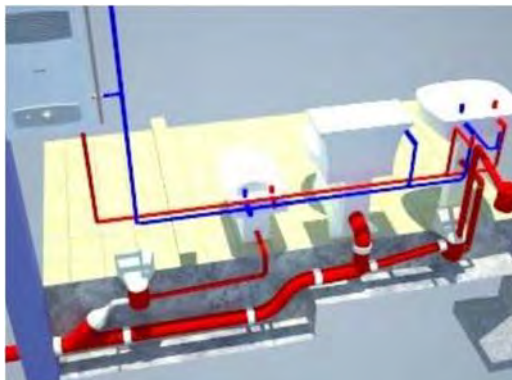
Detalle tipo de instalación de saneamiento y fontanería, 2016, CYPE
